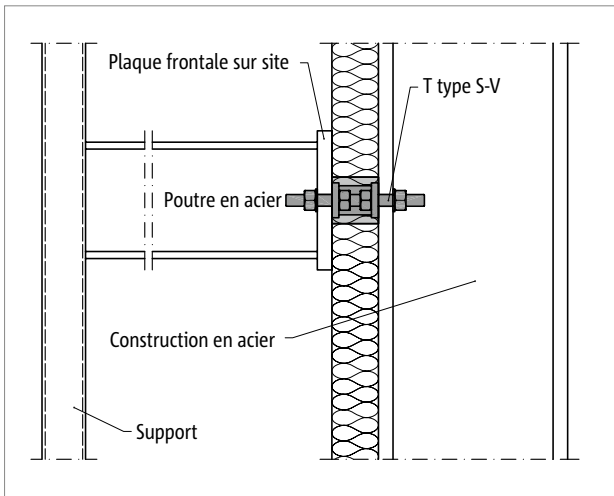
Schöck Isokorb® T type S-V : structure en acier soutenue
